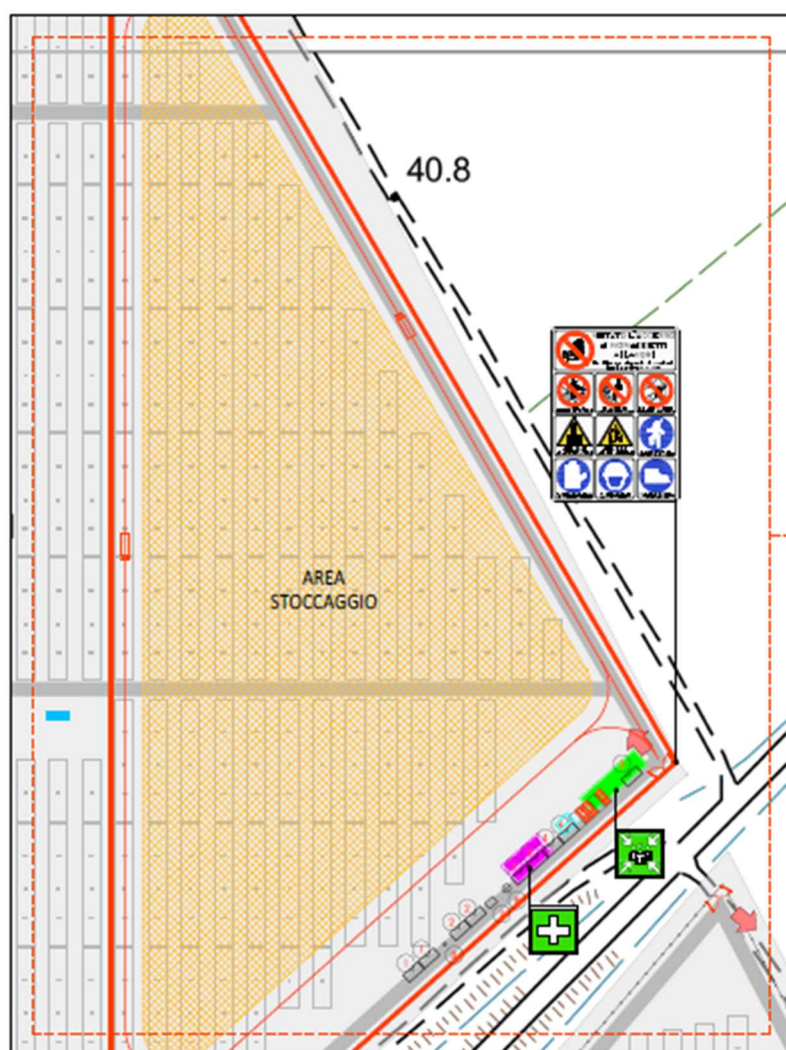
Stralcio dell'area stoccaggio di cantiere, all'interno del campo S2
